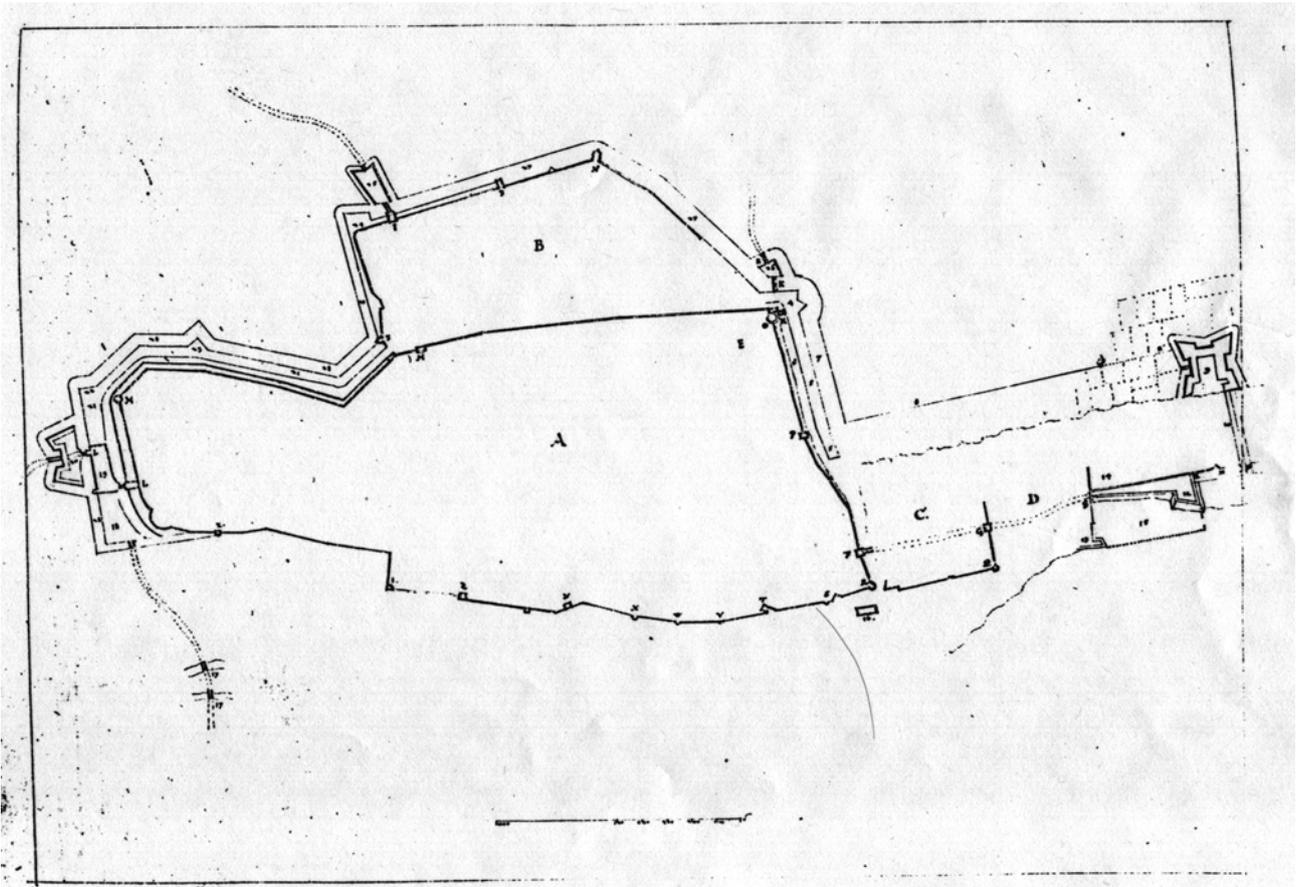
Grundriss von Laurentius Engelhart mit Planungen zur Verbesserung der Befestigung, 1618-19. Bayrische Staatsbibliothek München, Sign. Cgm 1674, fol. 16v-18r. *Abbildung GDKE RLP, Frau Dr. P. Heberer. Norden rechts.
